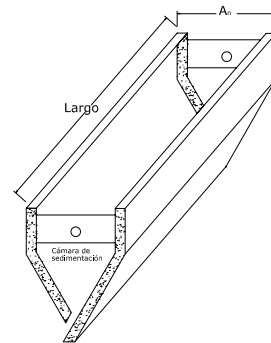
Esquema general de la cámara de sedimentación
